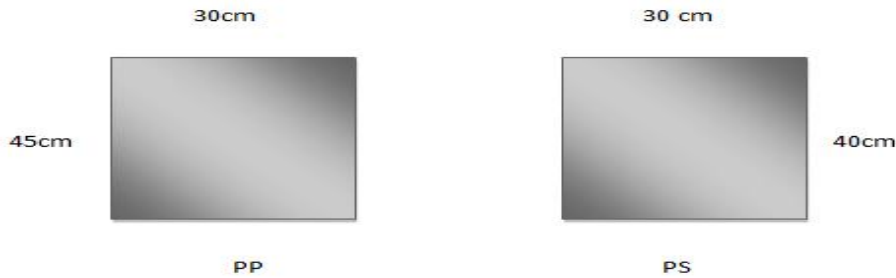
Les dimensions de la poutre principale et la poutre secondaire.
